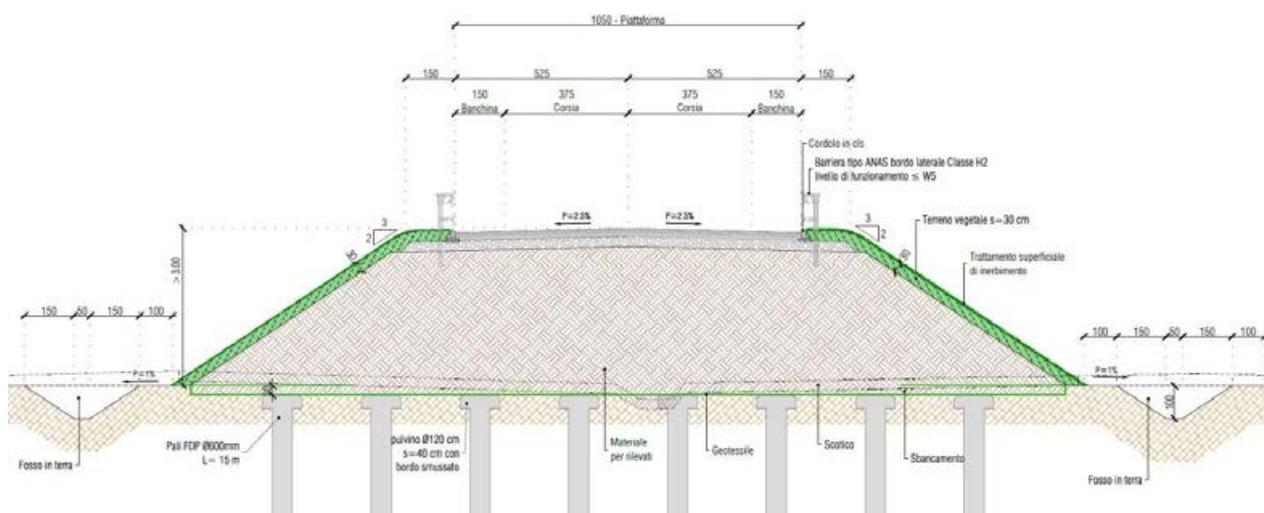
SEZIONE TIPO DI PROGETTO VARIANTE "ARMELLINA" PER RILEVATI ALTI (PER H FINO A 2.5 M)
